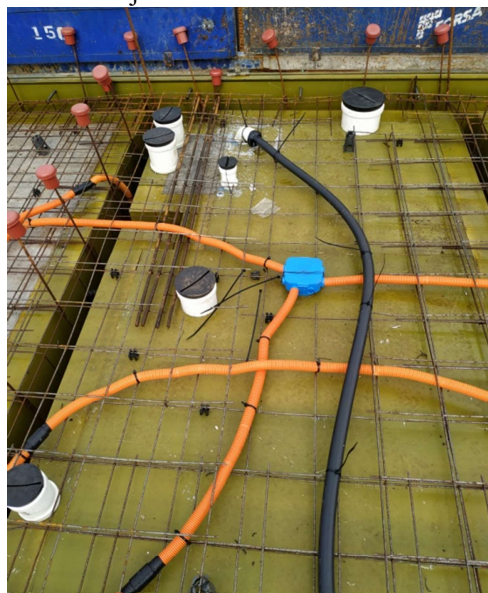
Execução das instalações elétricas na laje em concreto armado
